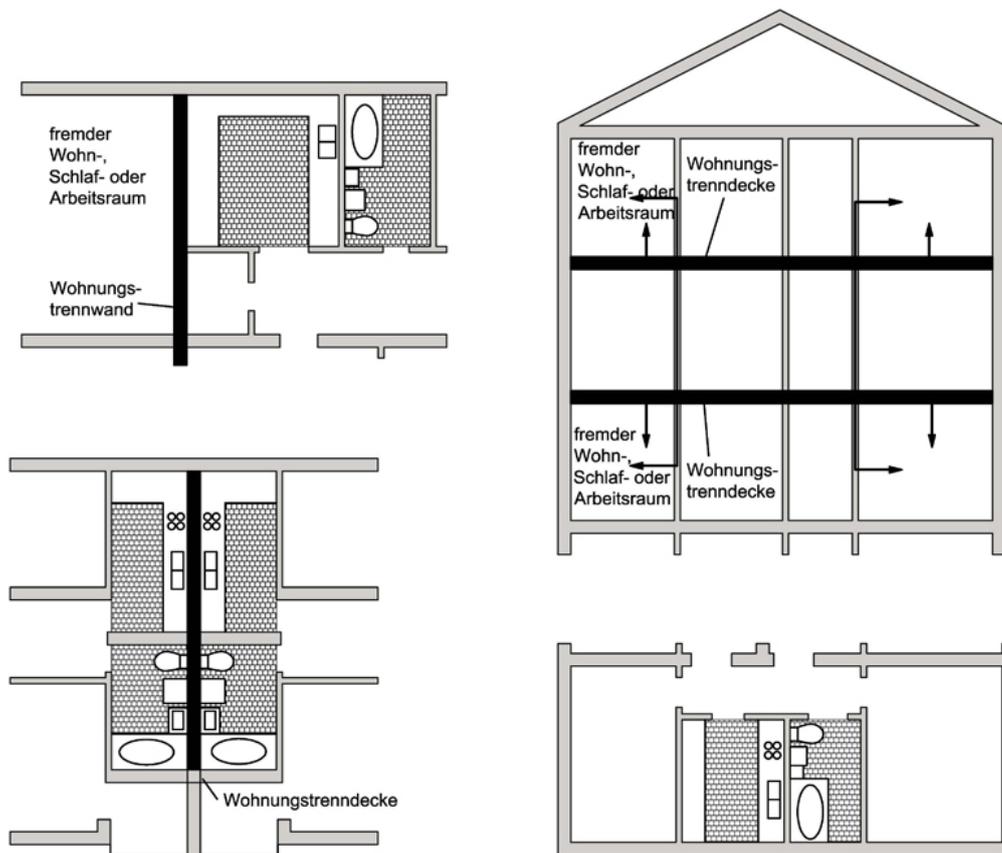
Beispiele für bauakustisch günstige Grundrisslösungen
